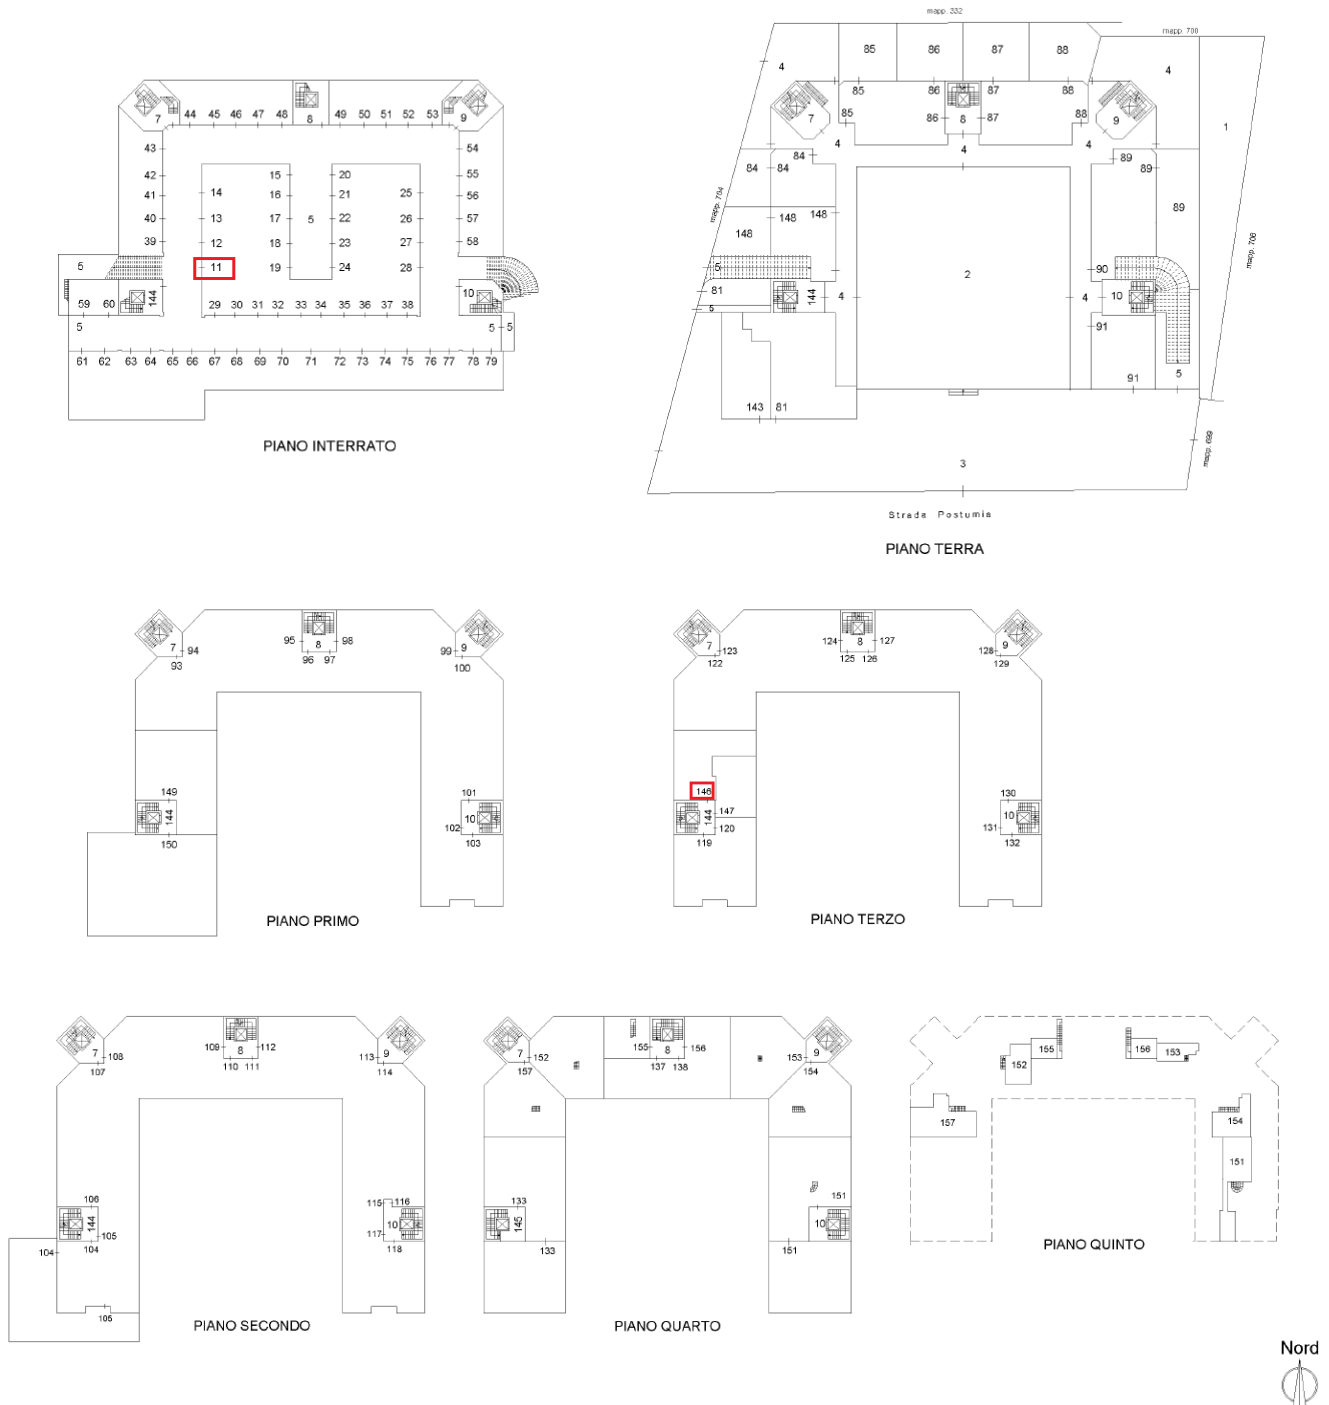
Planimetria subalterni ([Allegato N.4](#))
